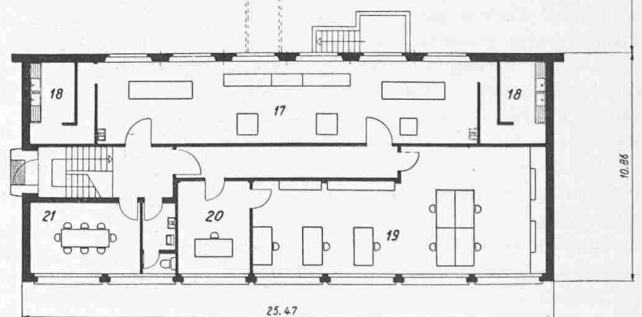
Grundriss des Erdgeschosses, Masstab 1:350
